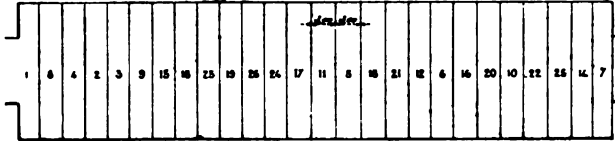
Schéma de la marche générale suivie pour la construction de la voûte de la station « Place de l'Europe ».
